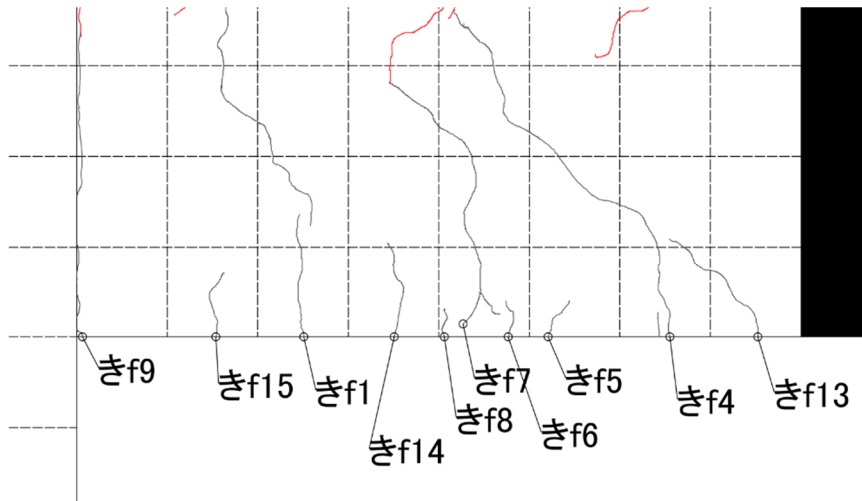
基礎梁南ひび割れ幅測定位置(試験体 DR-5 +7.0 サイクル 観測面)
